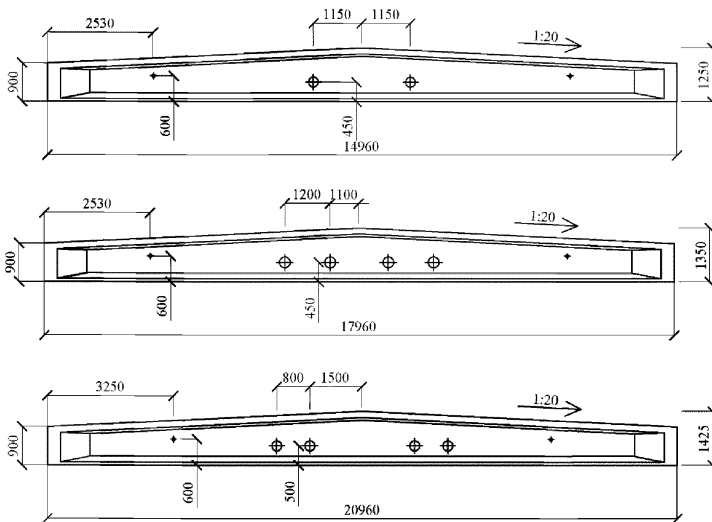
Двускатные стропильные балки двутаврового сечения
